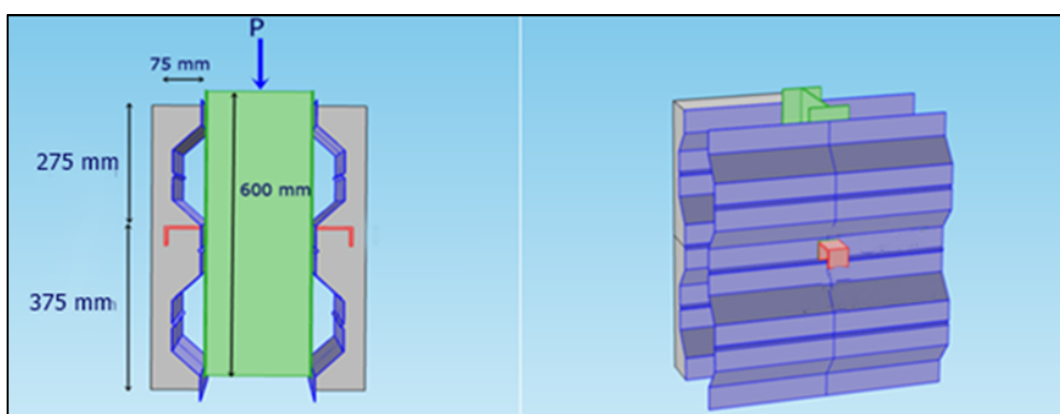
Vista de detalle del conector. Fuente: Autor.
